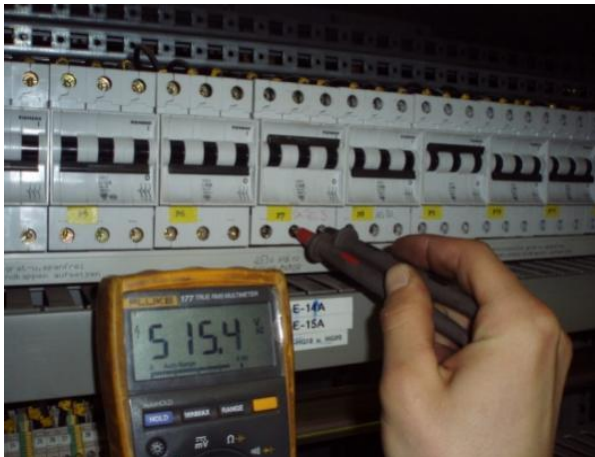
400V Leitungsschutzschalter wird mit 500VAC betrieben.
